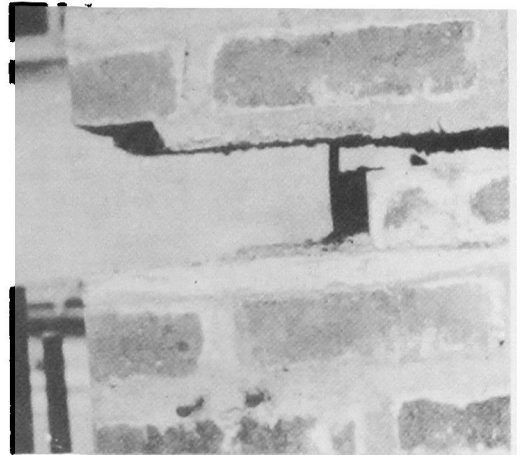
Muro R 3a de 25, detalle grieta.
